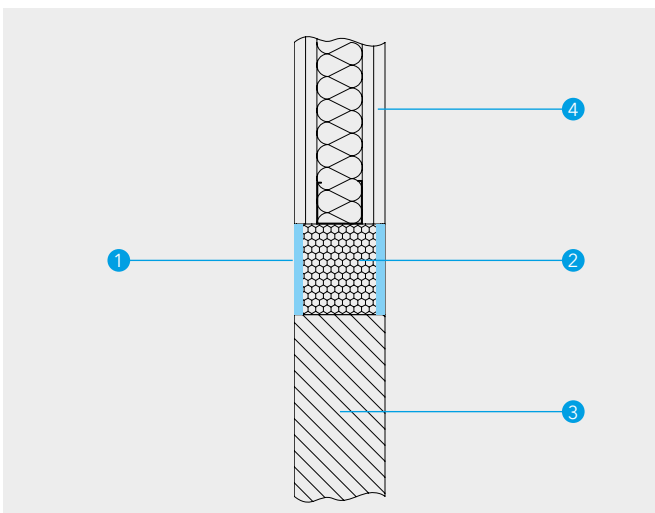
Detail C - Enkelzijdige voegafdichting in massieve wand - op onbrandbare rugvulling
